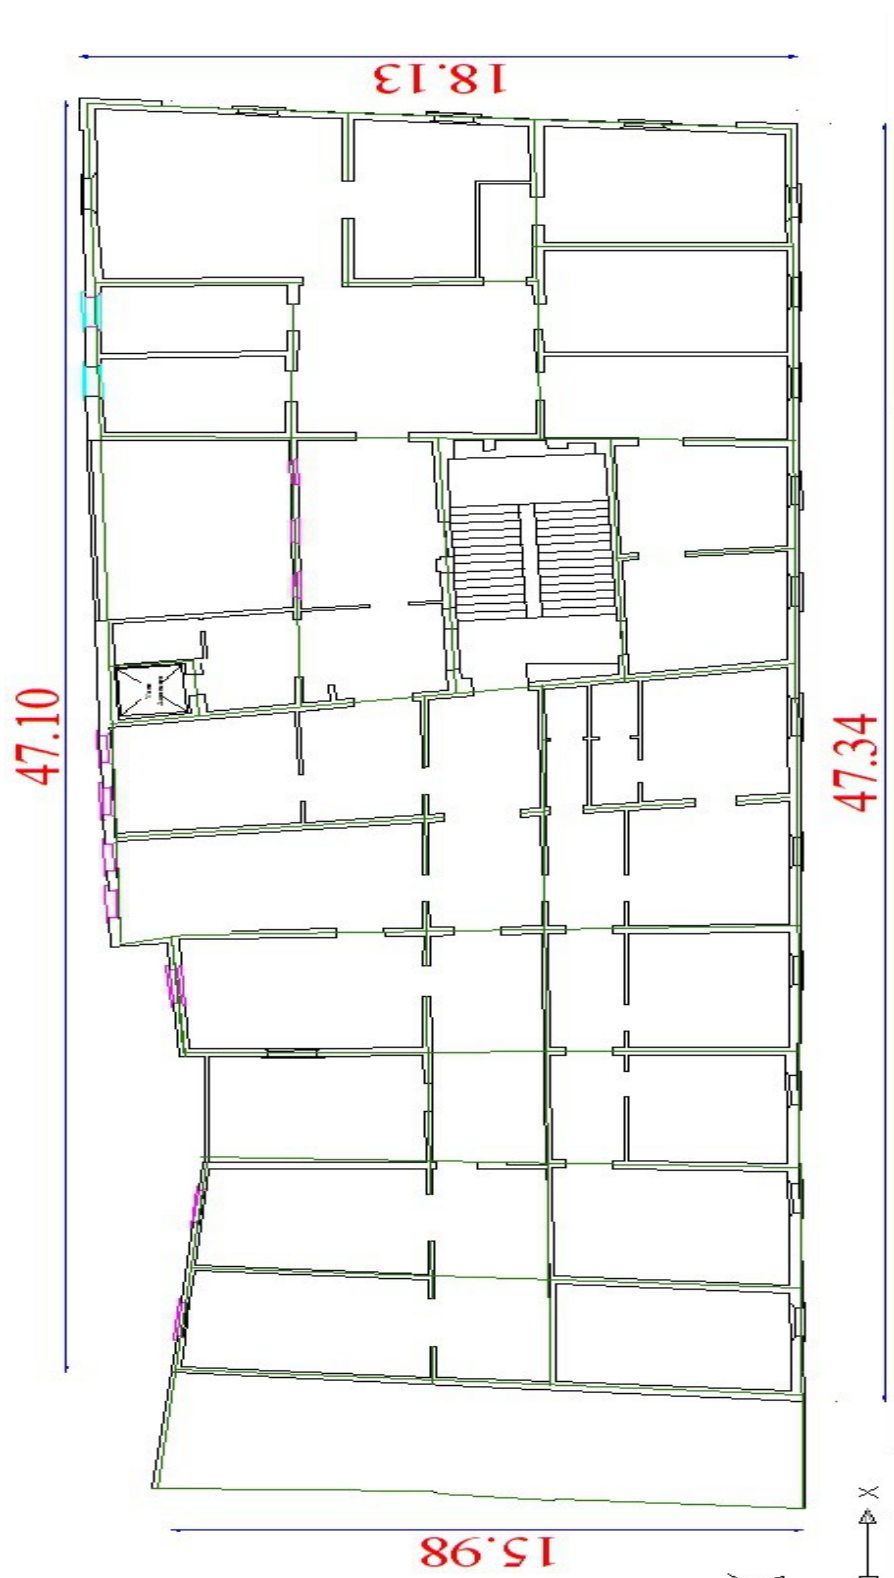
Planimetria piano terzo H.3,15 (disegno fuori scala)
